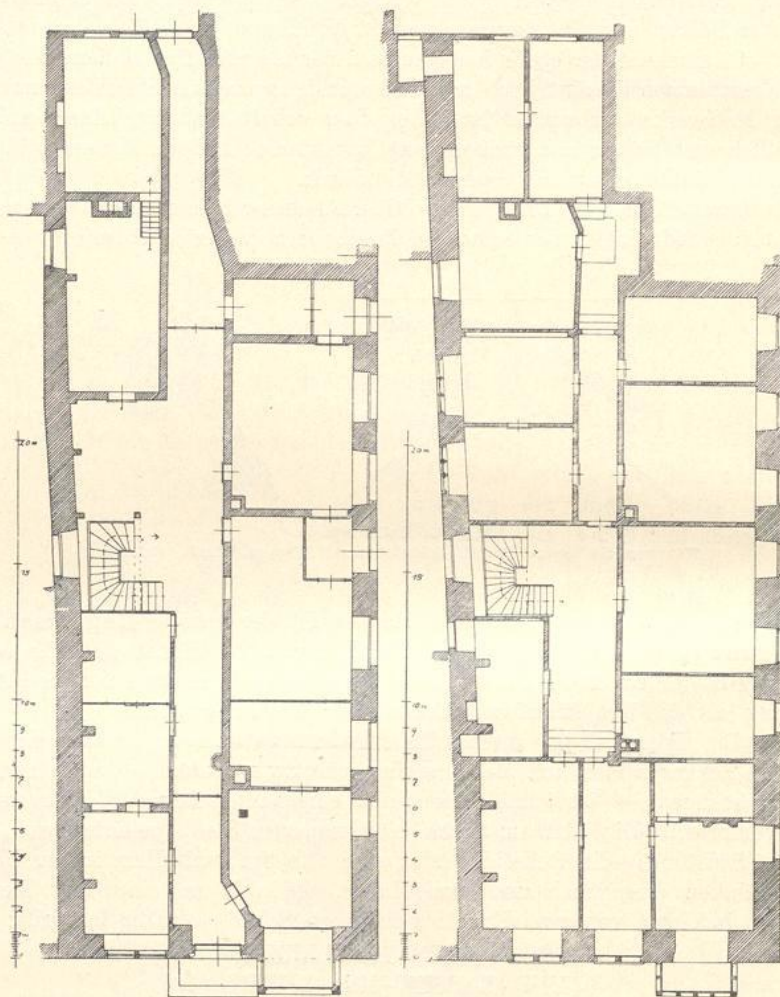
Rathausstr. 20. Haus van Harlessem. Grundrisse und erster Stock.
